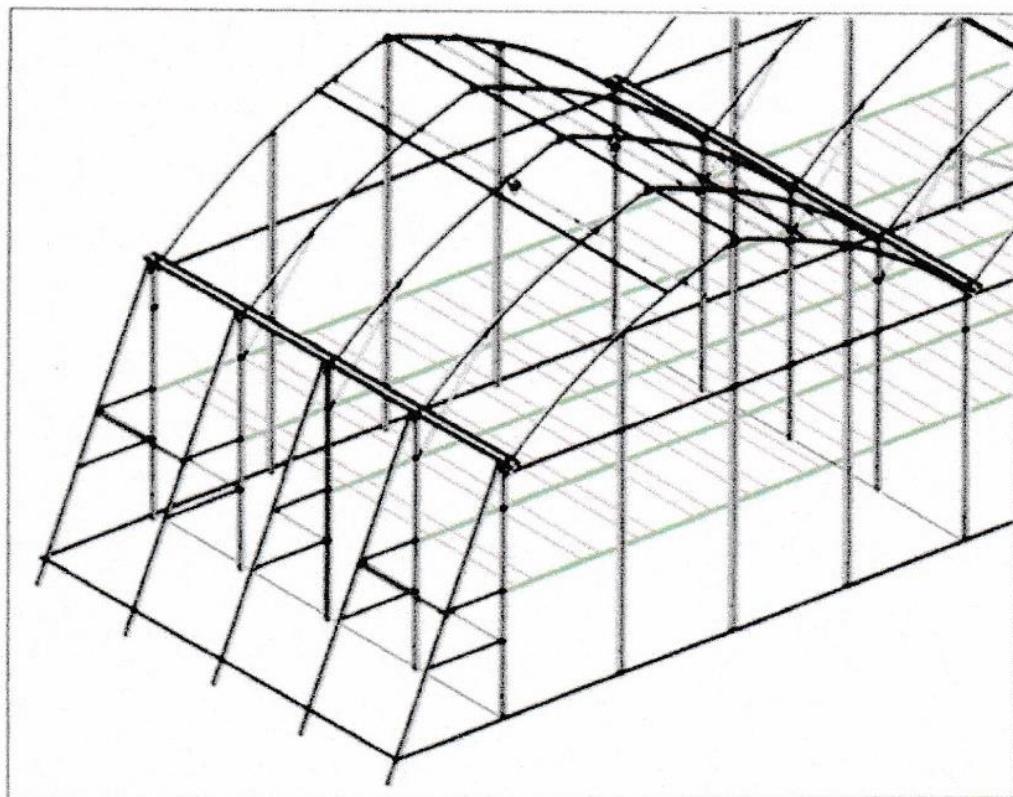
Detalle de la estructura interna y externa del módulo de invernadero
